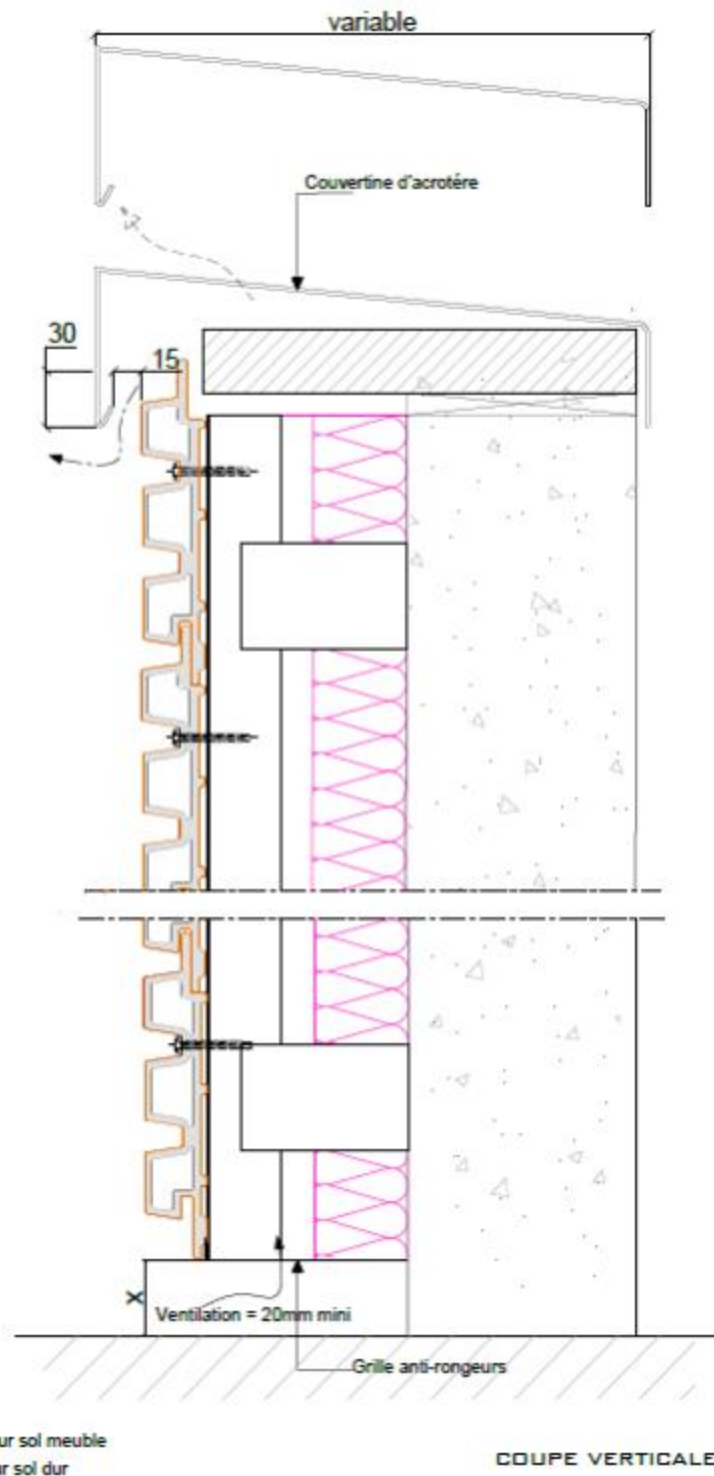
Départ et arrêt haut bardage sur ossature métallique en pose horizontale - Coupe verticale
